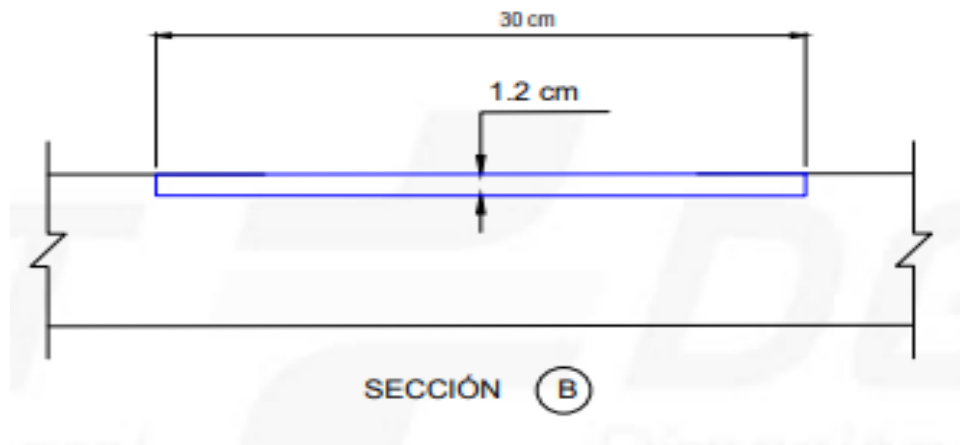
DGT (2018). Sección transversal de guía sonora longitudinal paralelogramo.
